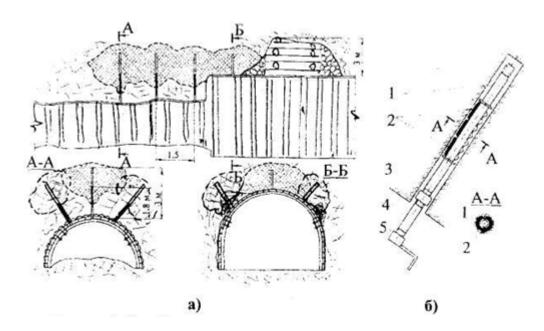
Схема расположения опережающих забой подрывки пород кровли шпуров для нагнетания скрепляющих веществ при перекреплении выработки (а) и герметирующего устройства (б):
